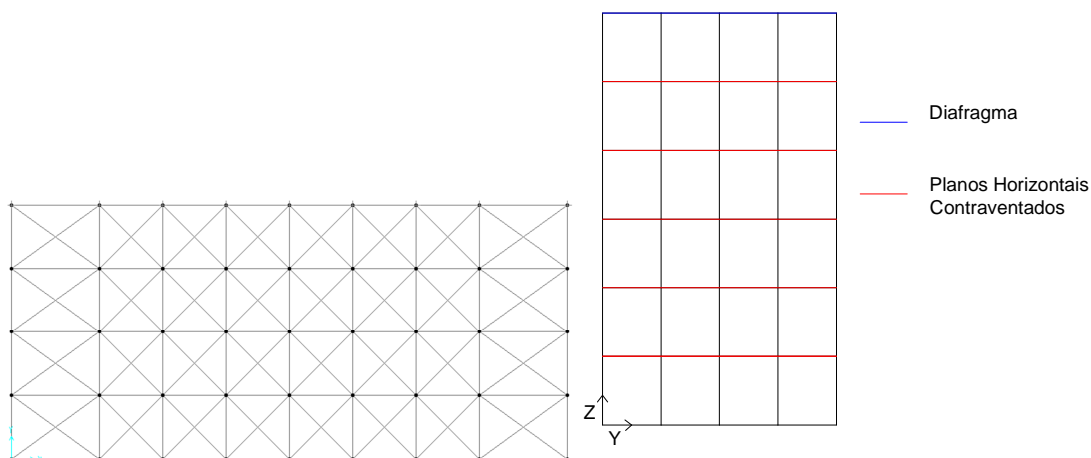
Configuração dos Planos de Contraventamento Horizontal Com Elementos de Contraventamento Pequenos
